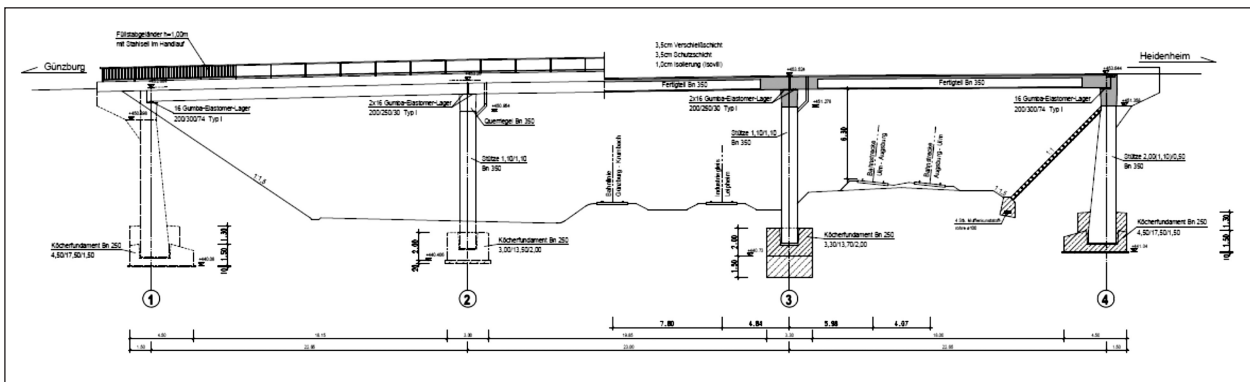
Bestandsplan, Bahnbrücke Heidenheimer Straße, Stadt Günzburg [40]
